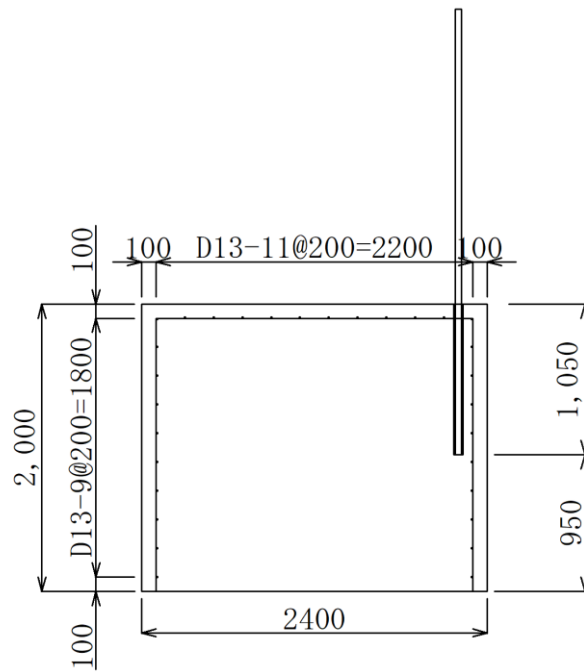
(6) 実験体②の配筋図 (A-A断面図)
